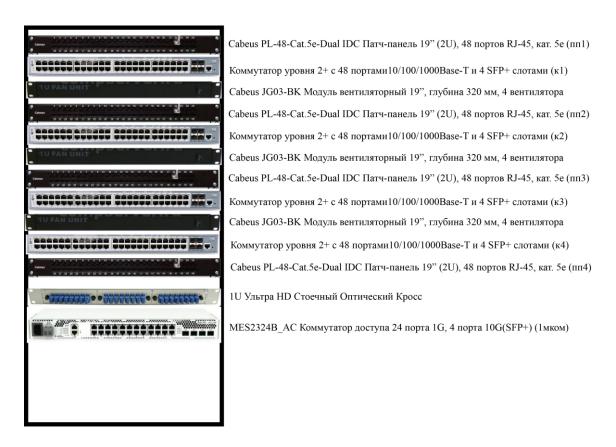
Фасад телекоммуникационного шкафа (Здание №5, этаж 2 и здание №7, этаж 1)
